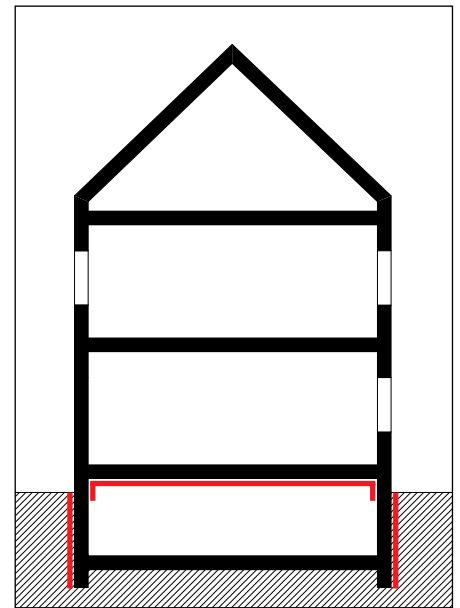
Nachträgliche Abdichtung und Dämmung einer Kelleraußenwand
